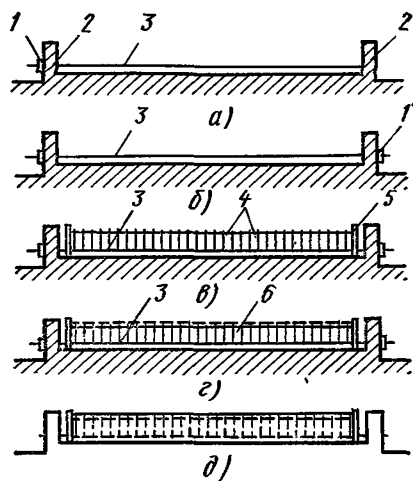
Этапы изготовления предварительно напряженной конструкции с натяжением арматуры на упоры: а — арматура до натяжения, б — арматура натянута, а ее концы закреплены на упорах анкерами, в — в опалубку или форму установлена ненапрягаемая арматура, г — конструкция забетонирована, д — готовая конструкция — бетон затвердел, усилие натяжения передано с упоров на бетон. 1 — анкер, 2 — упоры, 3 — напрягаемая арматура, 4 — ненапрягаемая арматура, 5 — опалубка или форма, 6 — бетонная смесь
